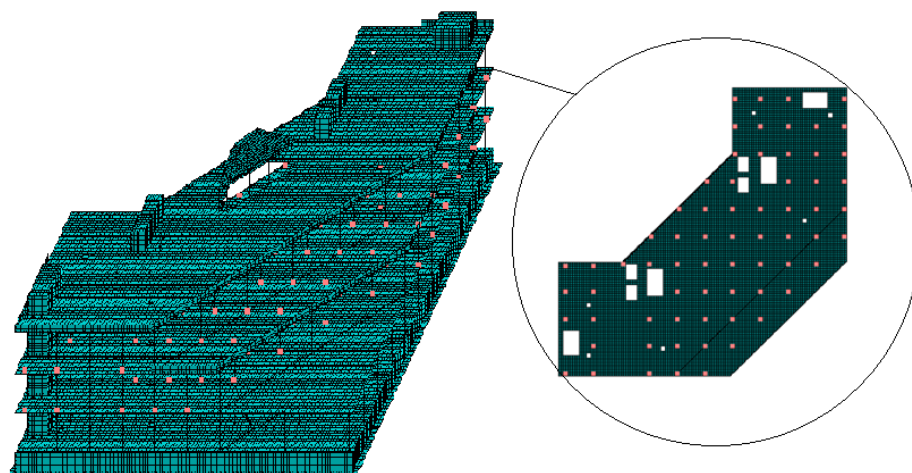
Расчетная схема стилобатной части здания и монолитной железобетонной плиты на отметке +12.000.
